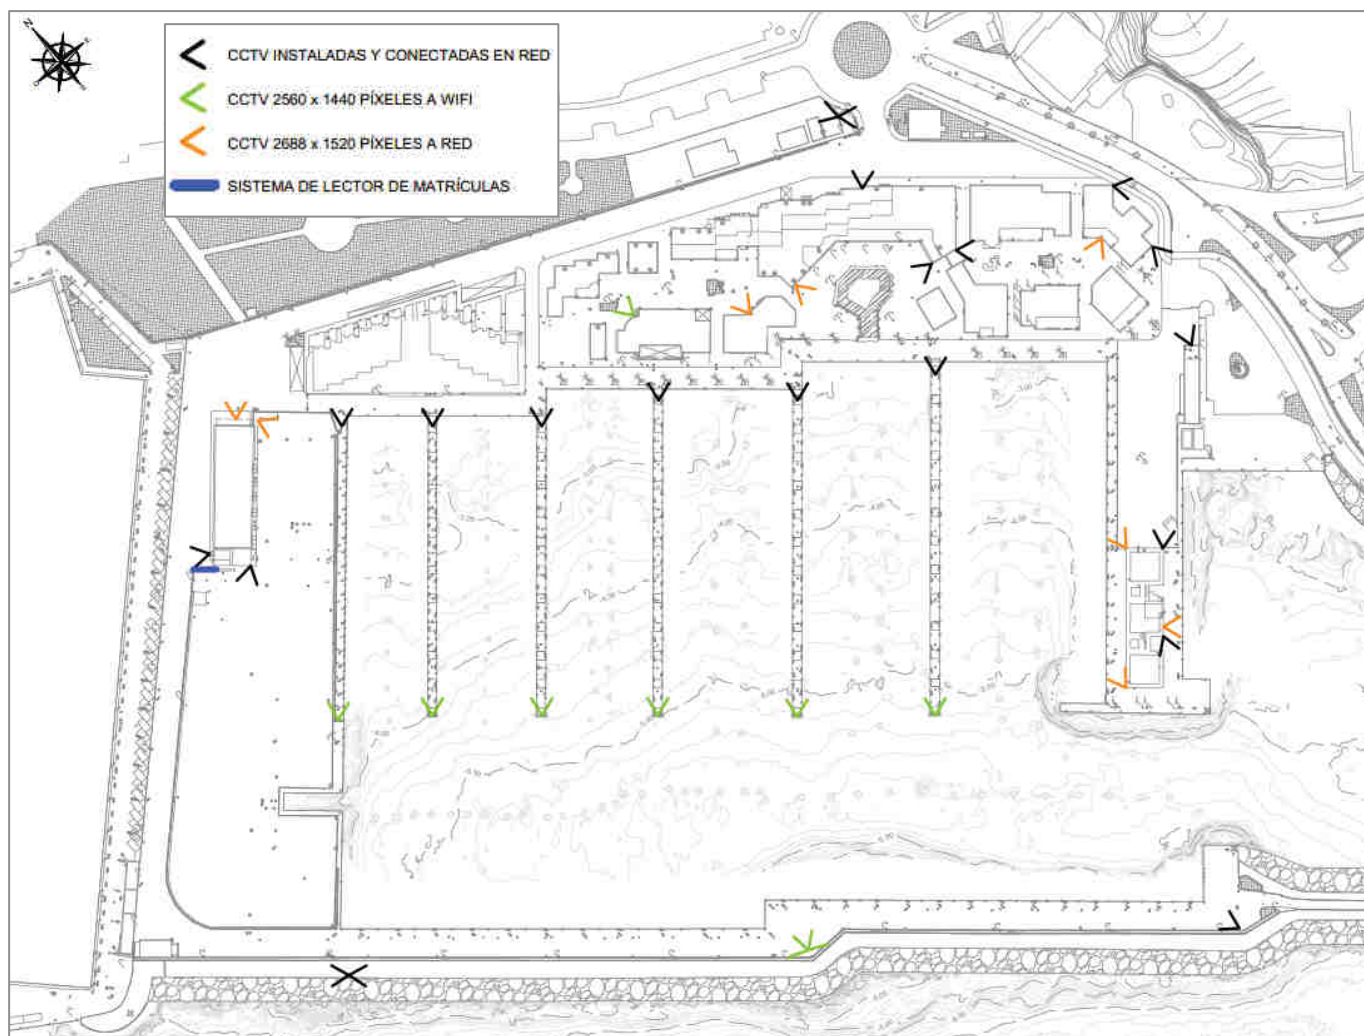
Planta general con la ubicación del sistema de cámaras CCTV
